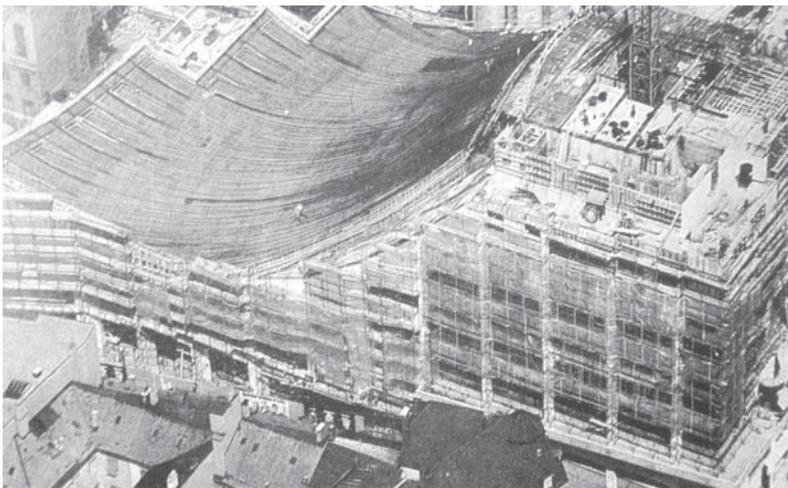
Cubierta laminar. Teatro de la Ópera de Basilea.
